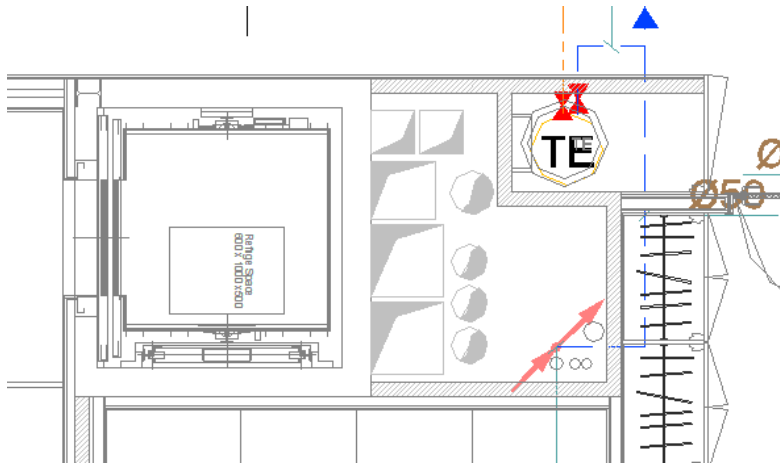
Pormenor da Courete atrás do poço do elevador
